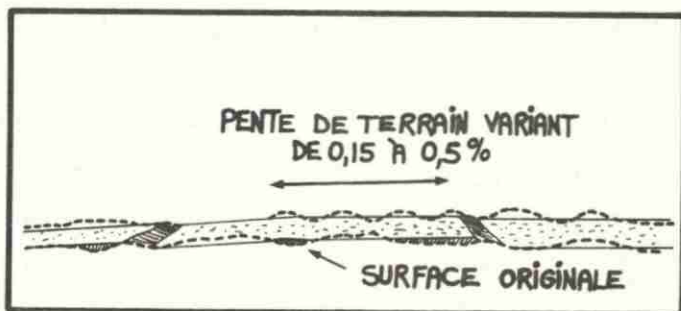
Lorsque la pente du terrain se situe entre 0,15 et 0,5 %, on pourra aménager des planches à l'versant. La raie de curage est toujours orientée selon la plus faible pente.
